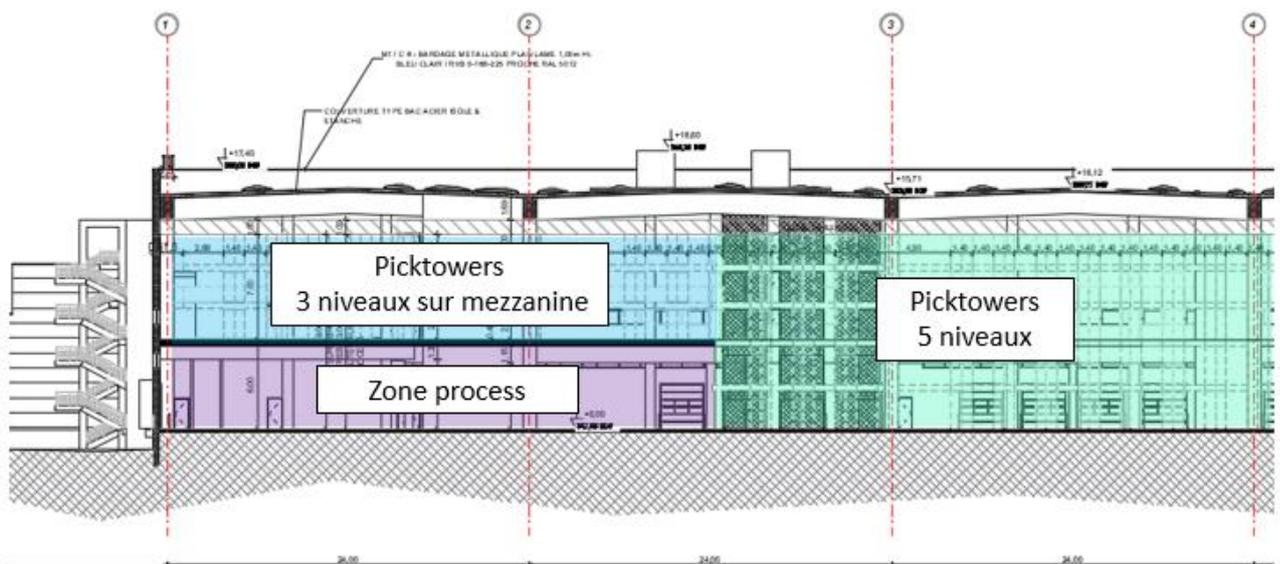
Coupe longitudinale entre les files 1 et 4.
